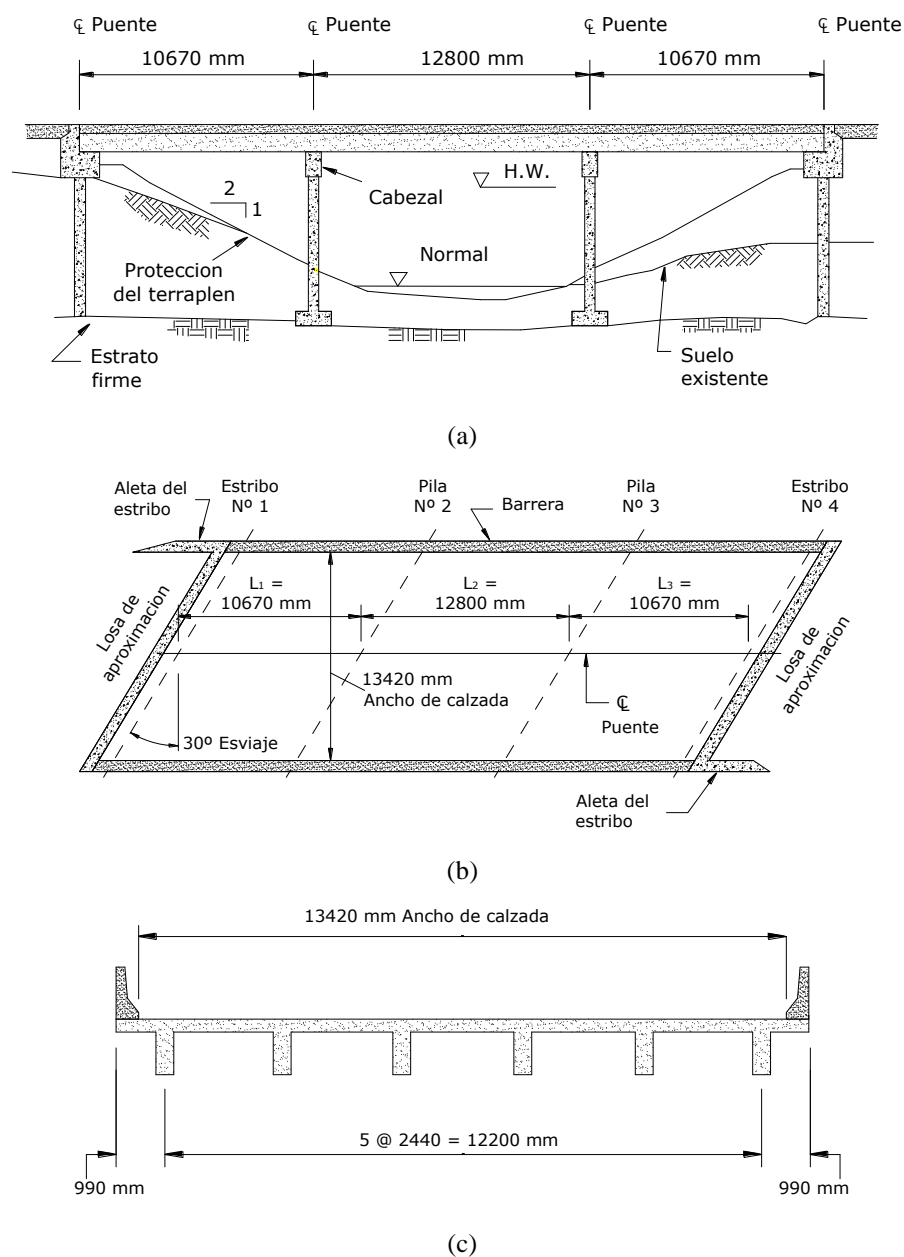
Ejemplo de diseño del puente de vigas T (a) Elevación, (b) Planta, (c) Sección
